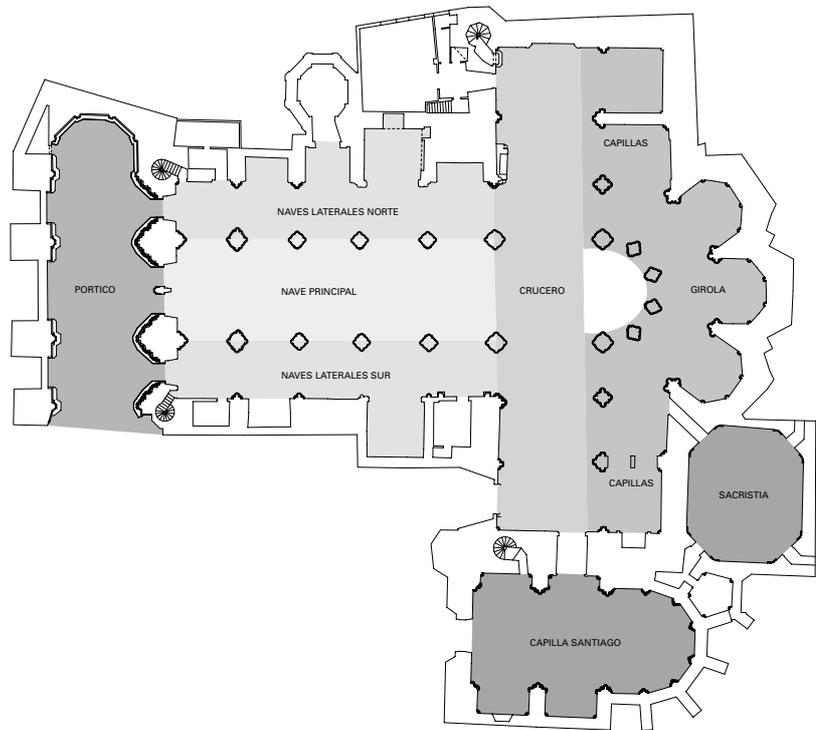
Zonas en las que se ha dividido la estructura de madera, para su estudio
